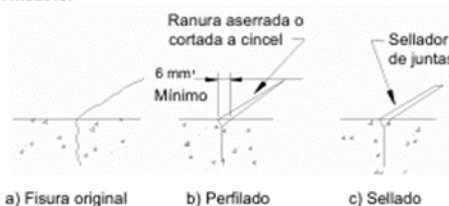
Reparación de una fisura mediante perfilado y sellado (Johnson, 1965)
